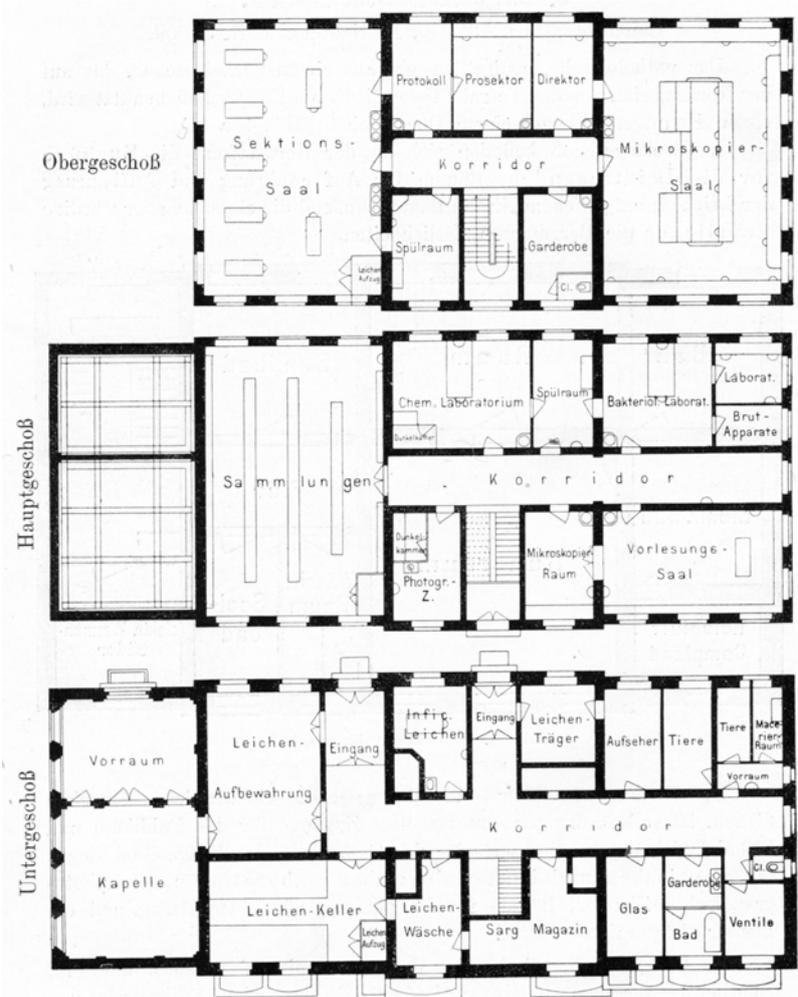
Pathologisches Institut 1905, Grundrisse
